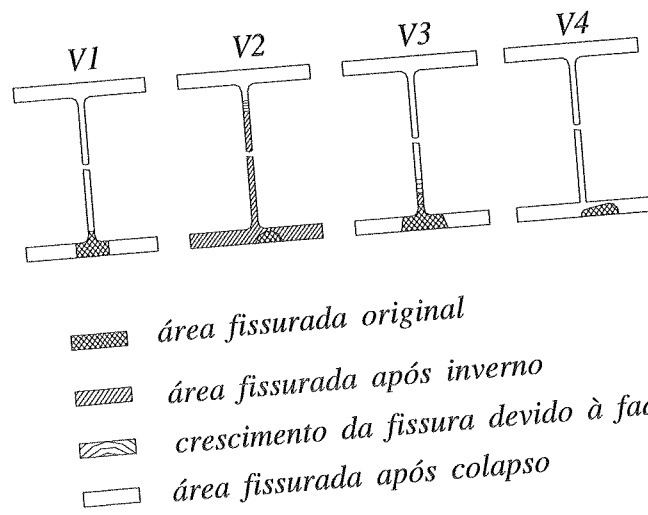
Representação Esquemática da Propagação da Trinca nas Vigas Principais da Kings Bridge.
